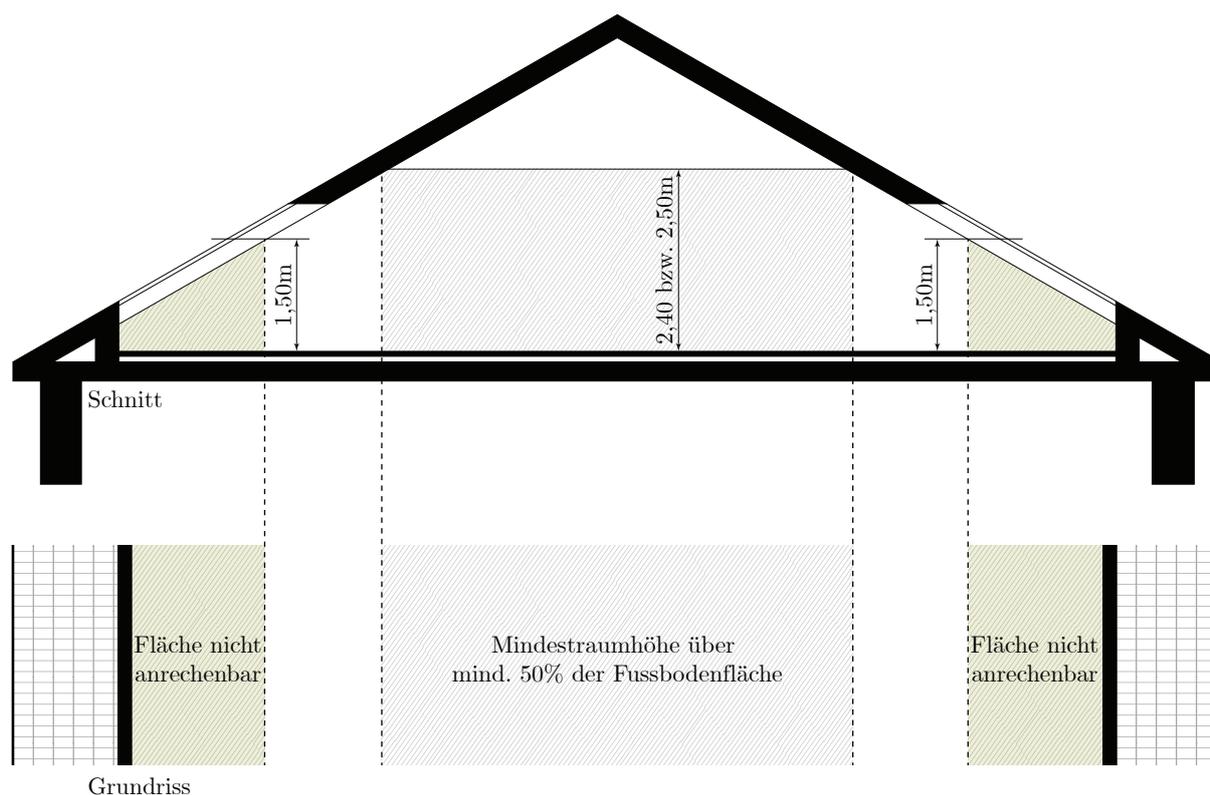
Mindestraumhöhe im Dachgeschoß © OIB-RL 3, 2015.
